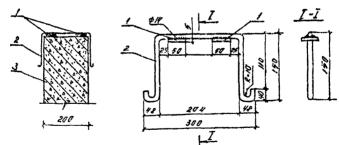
Хомут. Вариант по сборным железобетонным балкам перекрытия.
